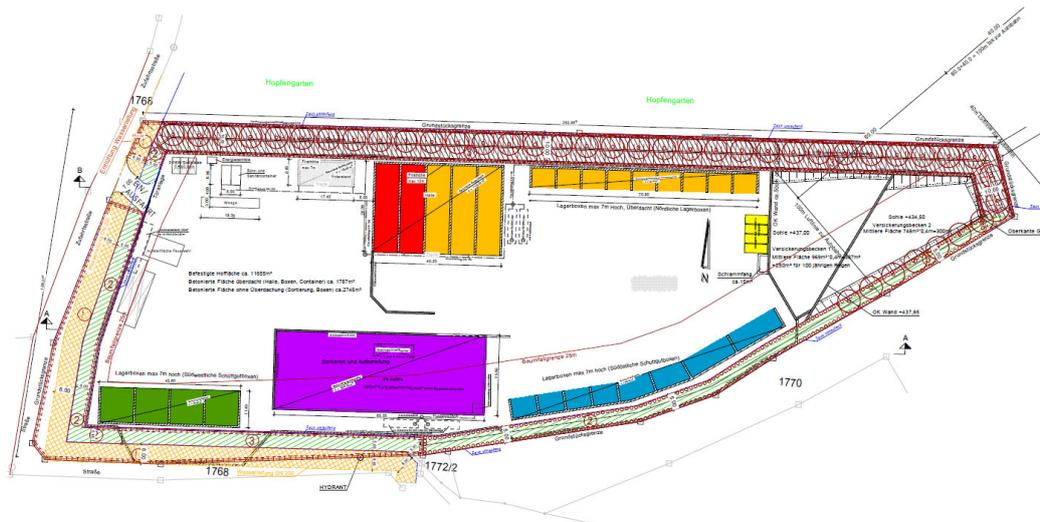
Lageplan Lagerplatz mit Recycling- und Aufbereitungsanlage (Halle rot/orange, Lagerboxen orange/grün/blau, Fläche Sortieren und Aufbereitung violett), Quelle: Ausschnitt aus Eingabeplanung Zwingler Ingenieurbüro
